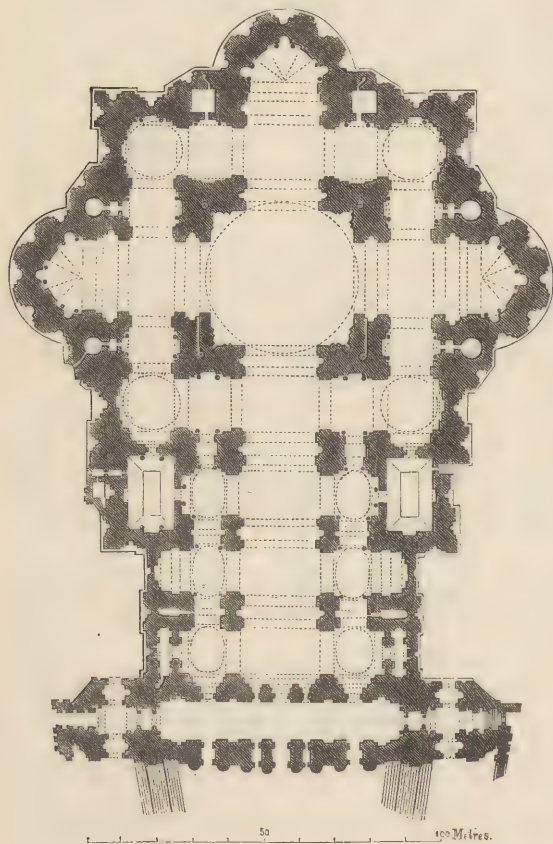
St. Peter zu Rom. Grundriss.
